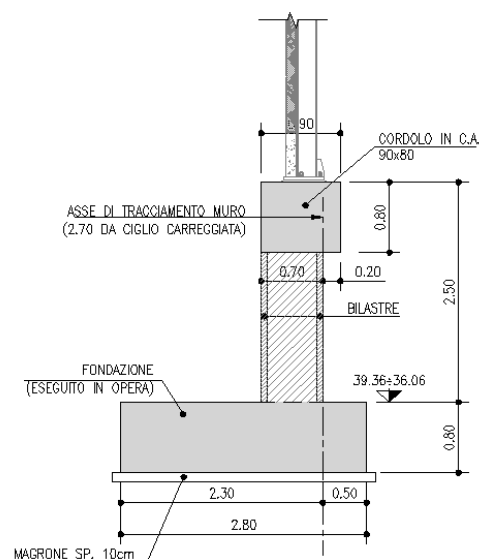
Sezione tipo opera di sostegno MS02 (elevazione H=2.50m)
